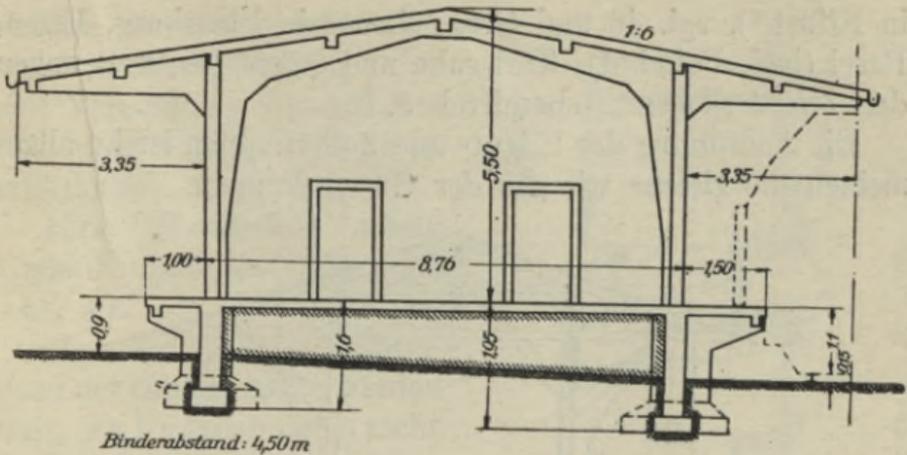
Querschnitt durch den Eilgutshuppen mit Eisenbetondach auf Bahnhof Itzehoe. M. 1 : 200.
